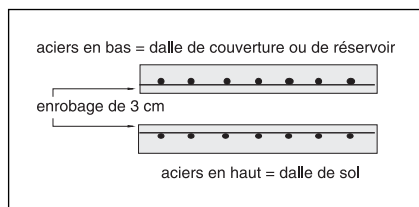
Placement des principaux aciers de ferrailage selon le type de dalle (dalle de sol ou de couverture).
